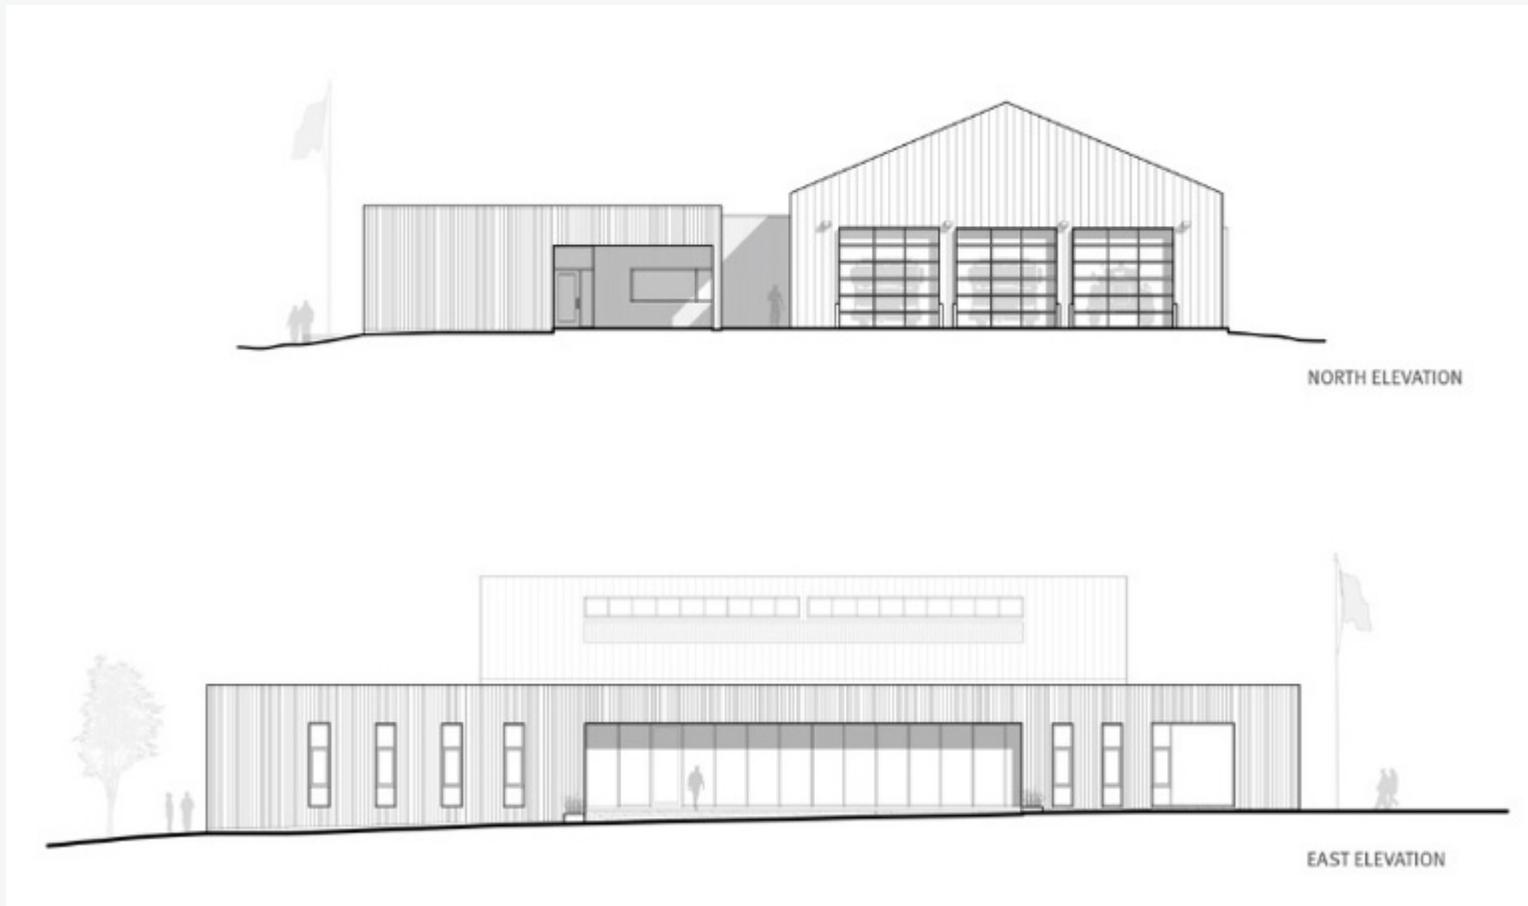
Elevación Norte y Elevación Este de Fire Station 76
